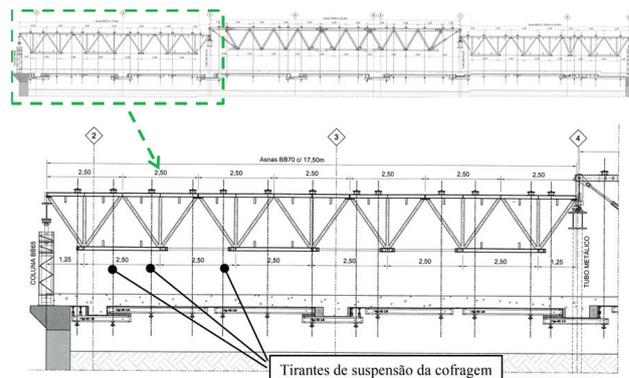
Asnas, tirantes de suspensão e estrutura já realizada na zona do *top/down
